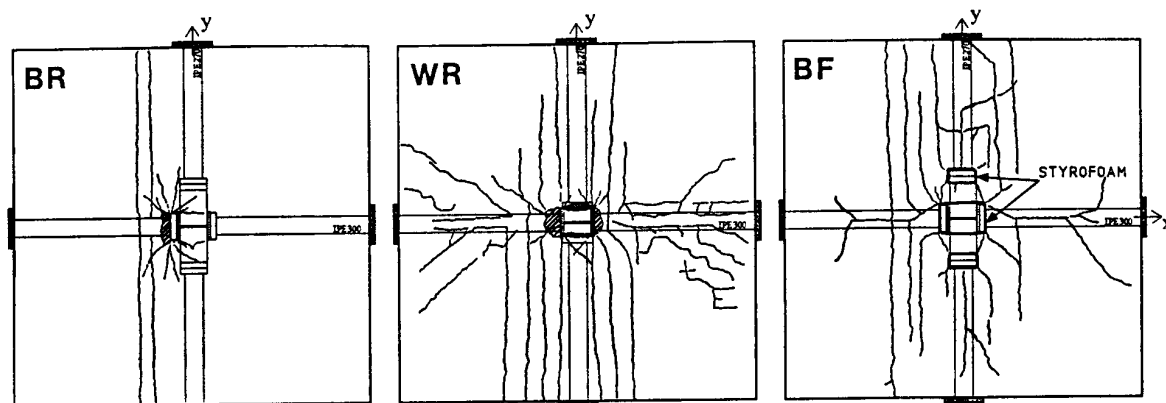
Fissures repérées à la surface des dalles des différents spécimens
